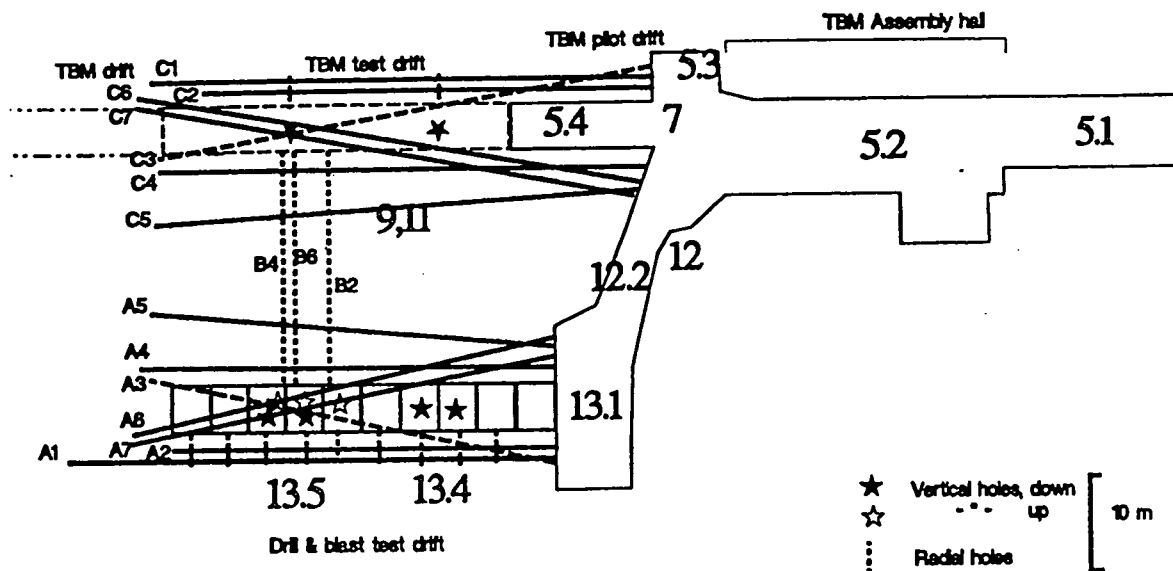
HRLの掘削計画と計測用ボーリング配置（平面図）
